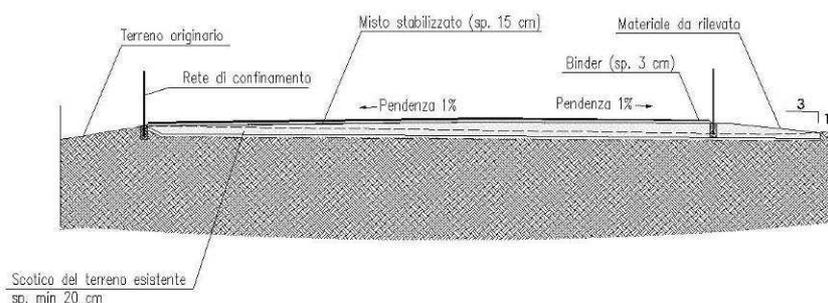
PARTICOLARE DELLA PAVIMENTAZIONE DELLE AREE DI CANTIERE
